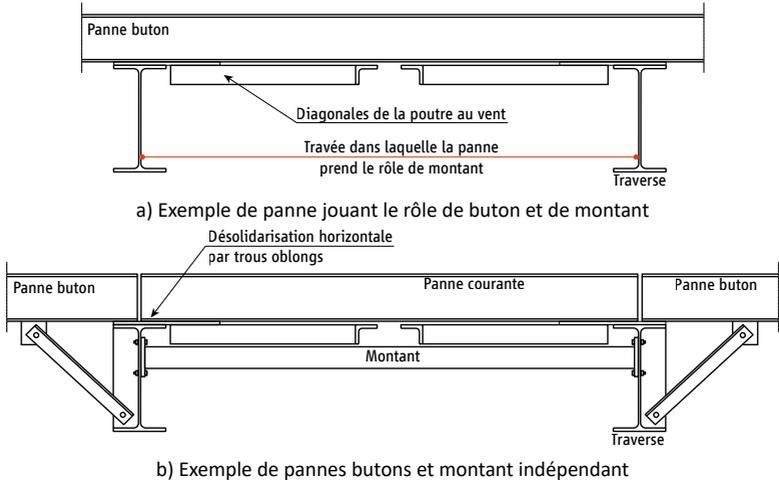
Dispositions constructives pour le montant d'une poutre au vent
